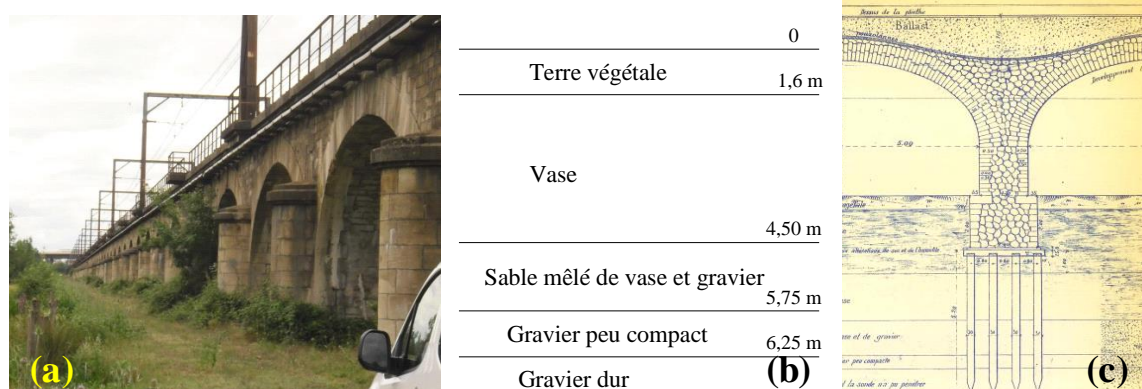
Vue de l'ouvrage (a), coupe géologique du site (b) et coupe longitudinale des fondations (c)
